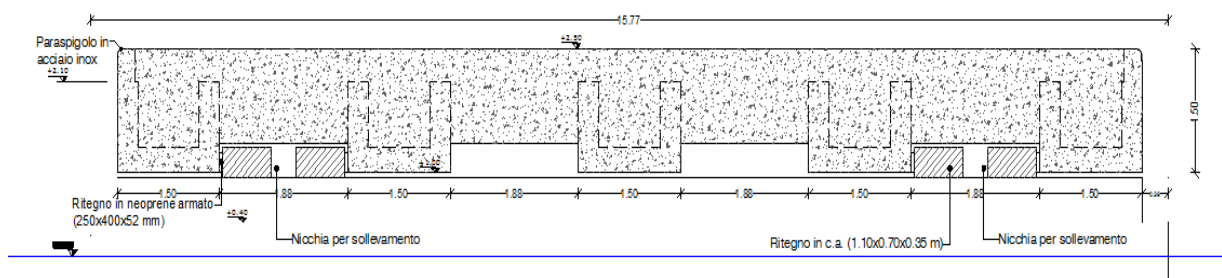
Trasverso di collegamento delle travi prefabbricate
